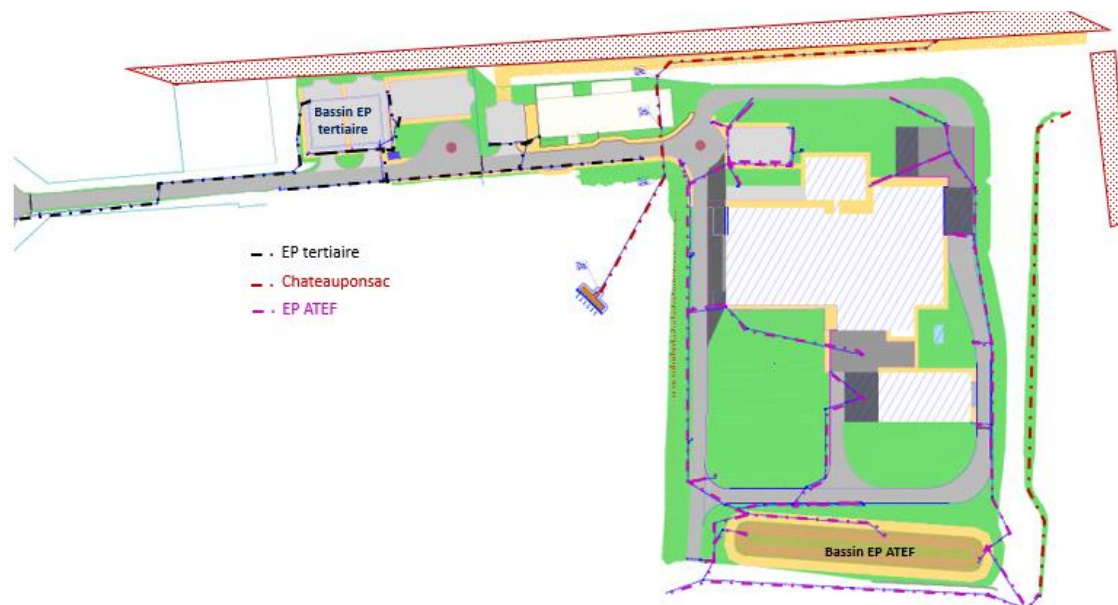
Plan des eaux pluviales extérieures à l'installation ATEF
